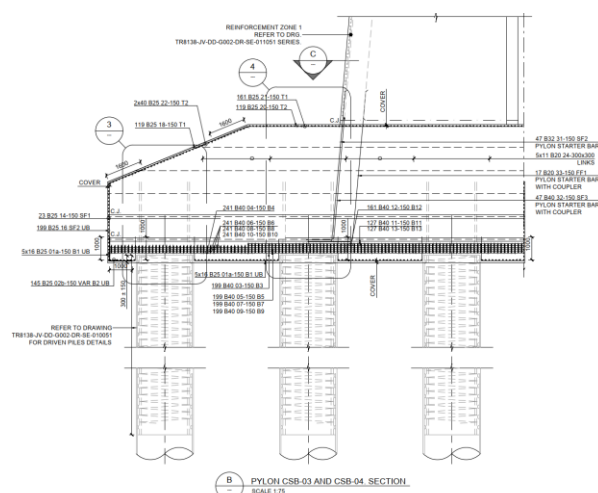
Sección por el encepado de un pilono (CSB03/CSB04).
